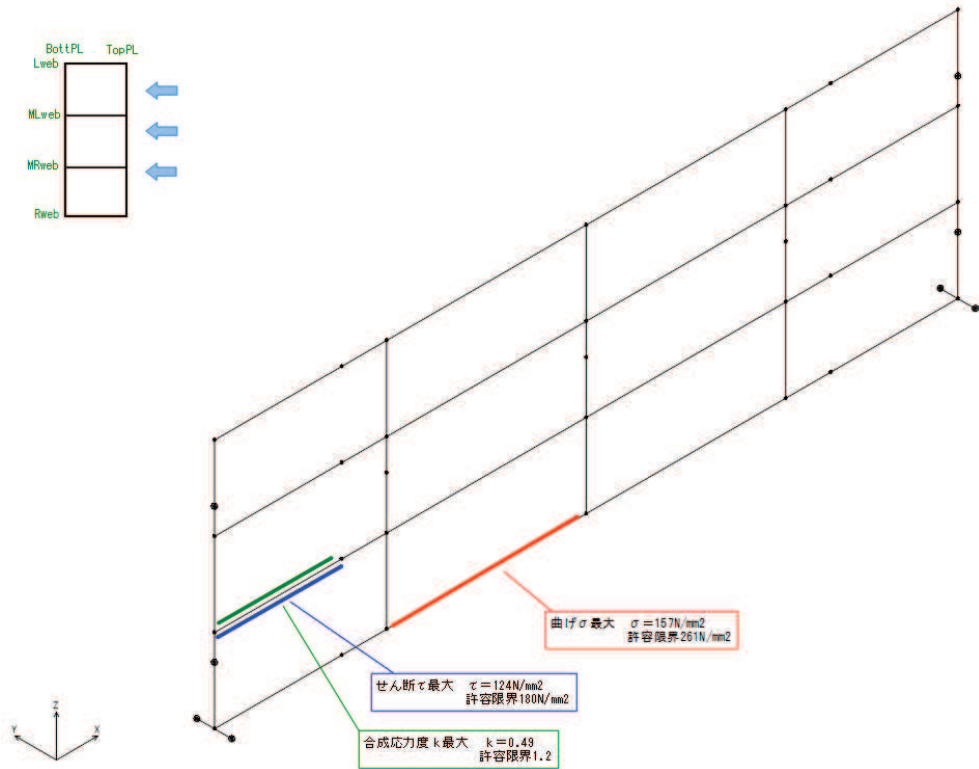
鋼桁の曲げ・軸力系の破壊及びせん断破壊に対する
